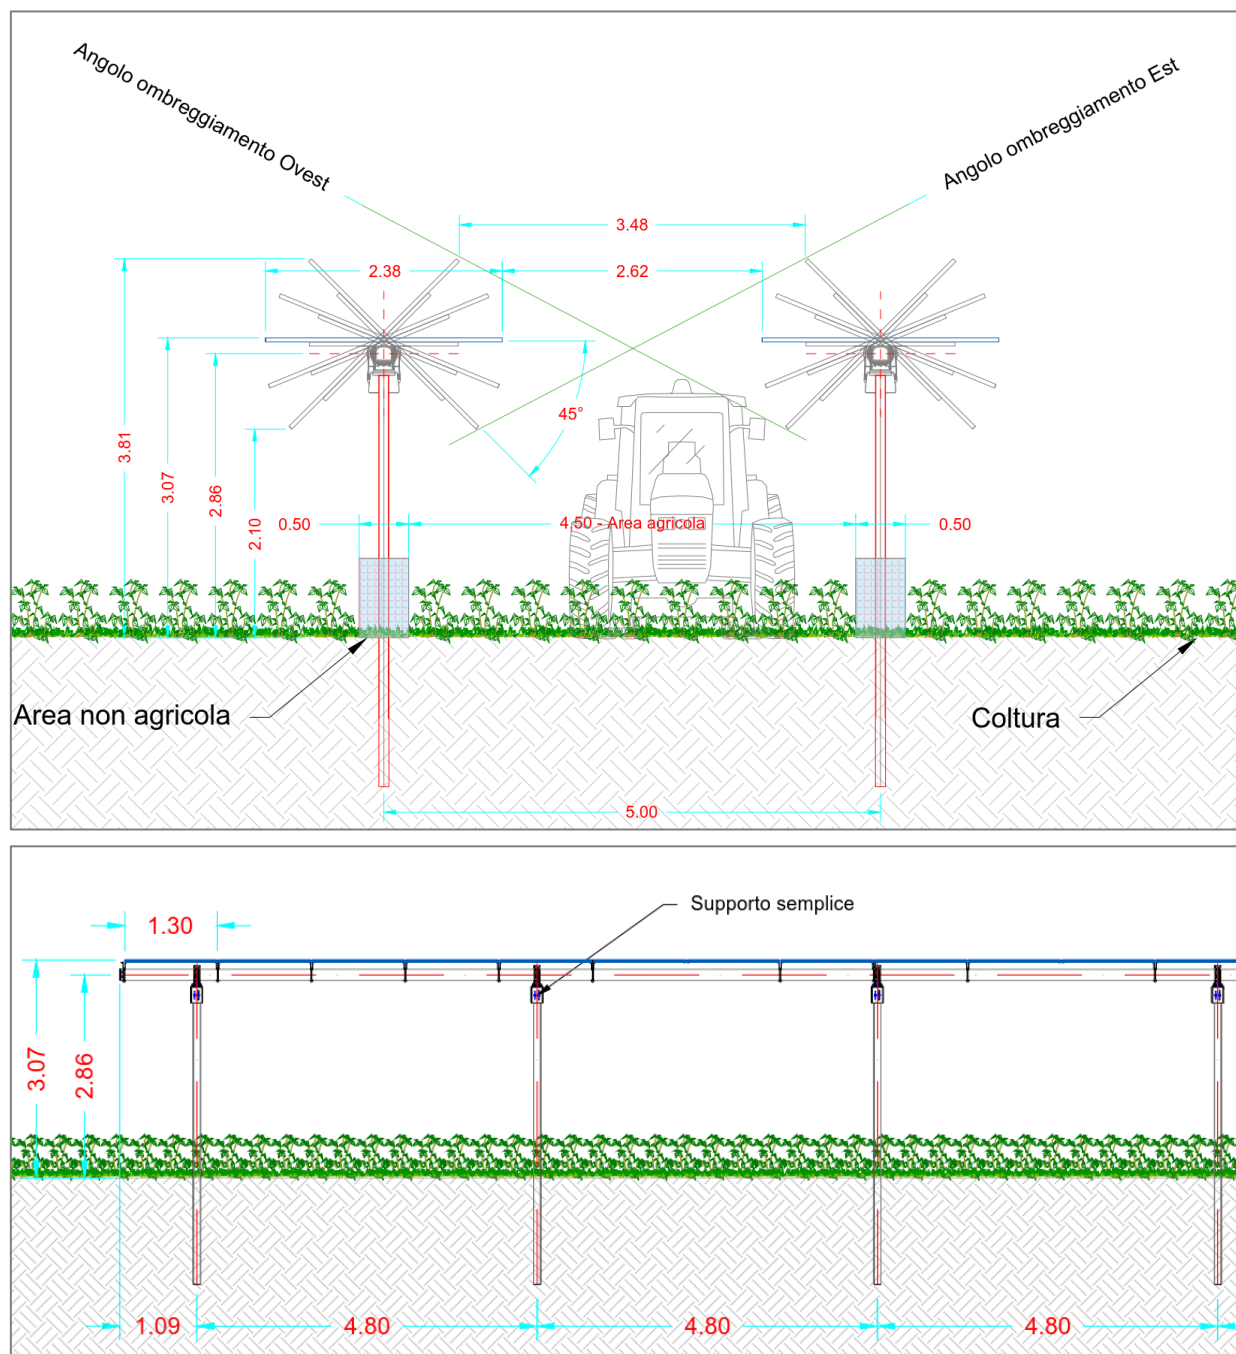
Sezione trasversale e longitudinale tipologica struttura Tracker – Area 05
